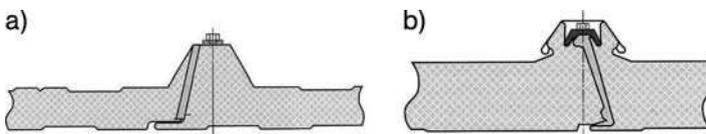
Längsrandüberdeckung bei Dach-Sandwichelementen – a) sichtbare, durchgeschraubte Befestigung, b) nicht sichtbare Befestigung
